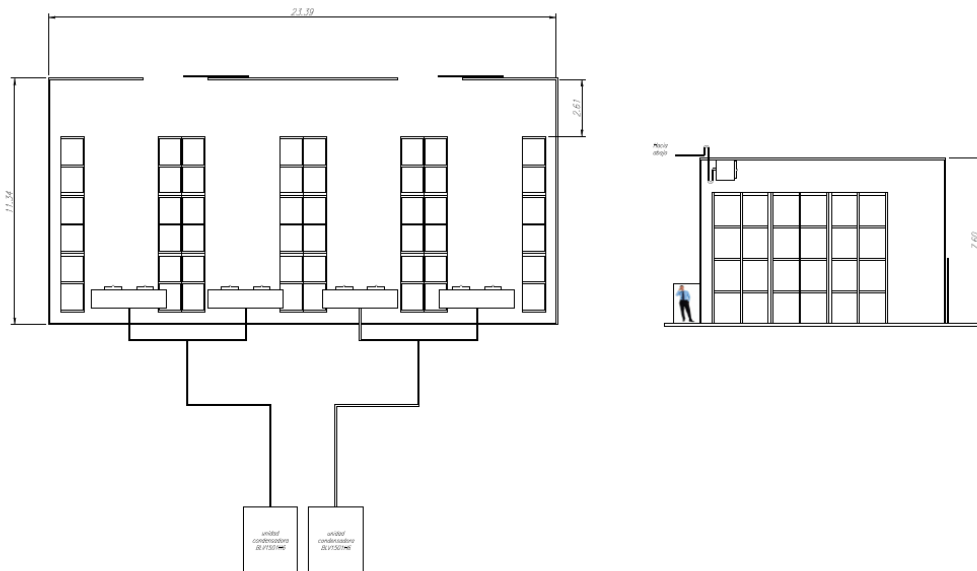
Vista de planta del cuarto de mantenimiento fresco.
